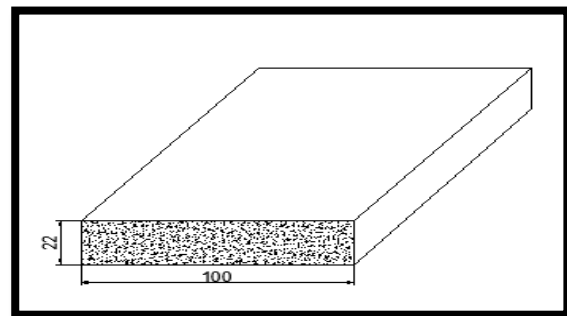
Une bande de 1 mètre de la dalle.
